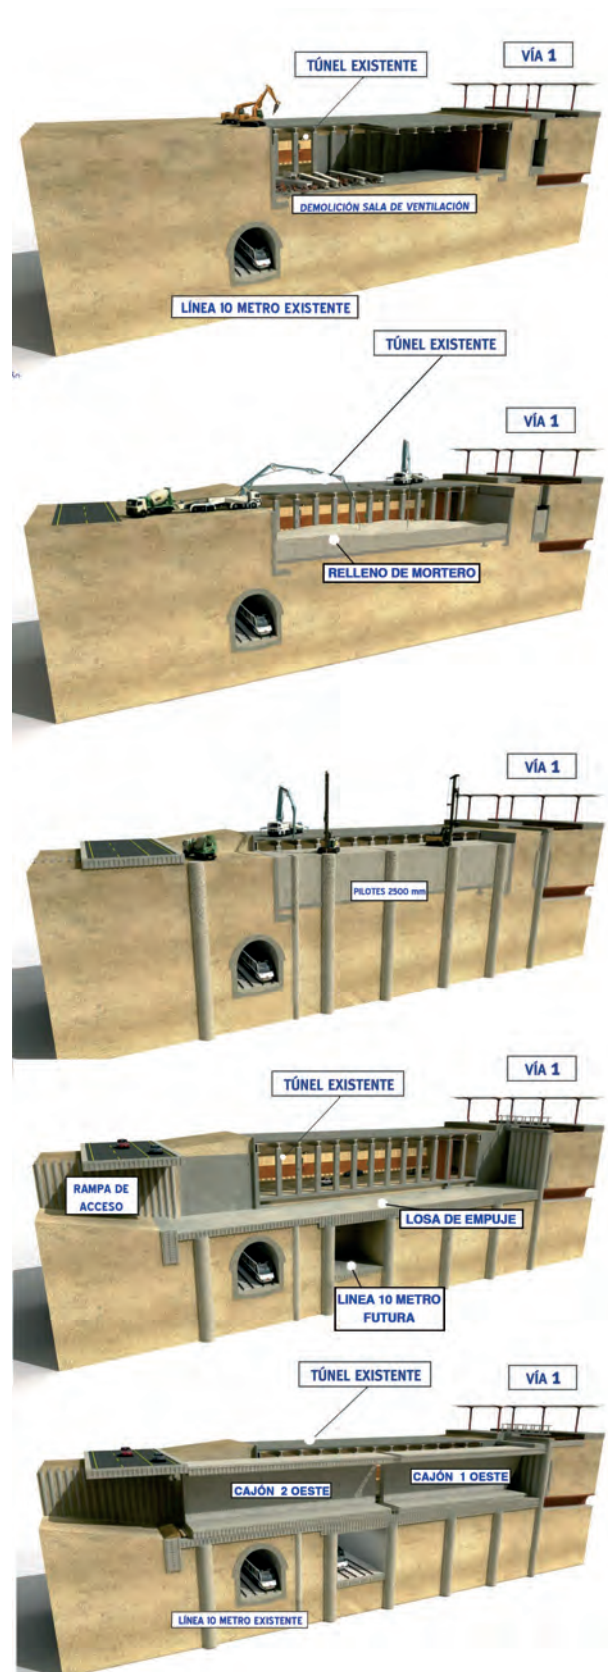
Proceso constructivo Foso Oeste/Construction of West pit.
